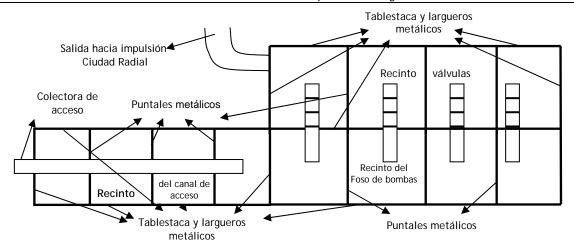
Vista en Planta de la Zona que debe llevar Tablestacas para Realizar las Excavaciones - Estación de Bombeo Juan Díaz
